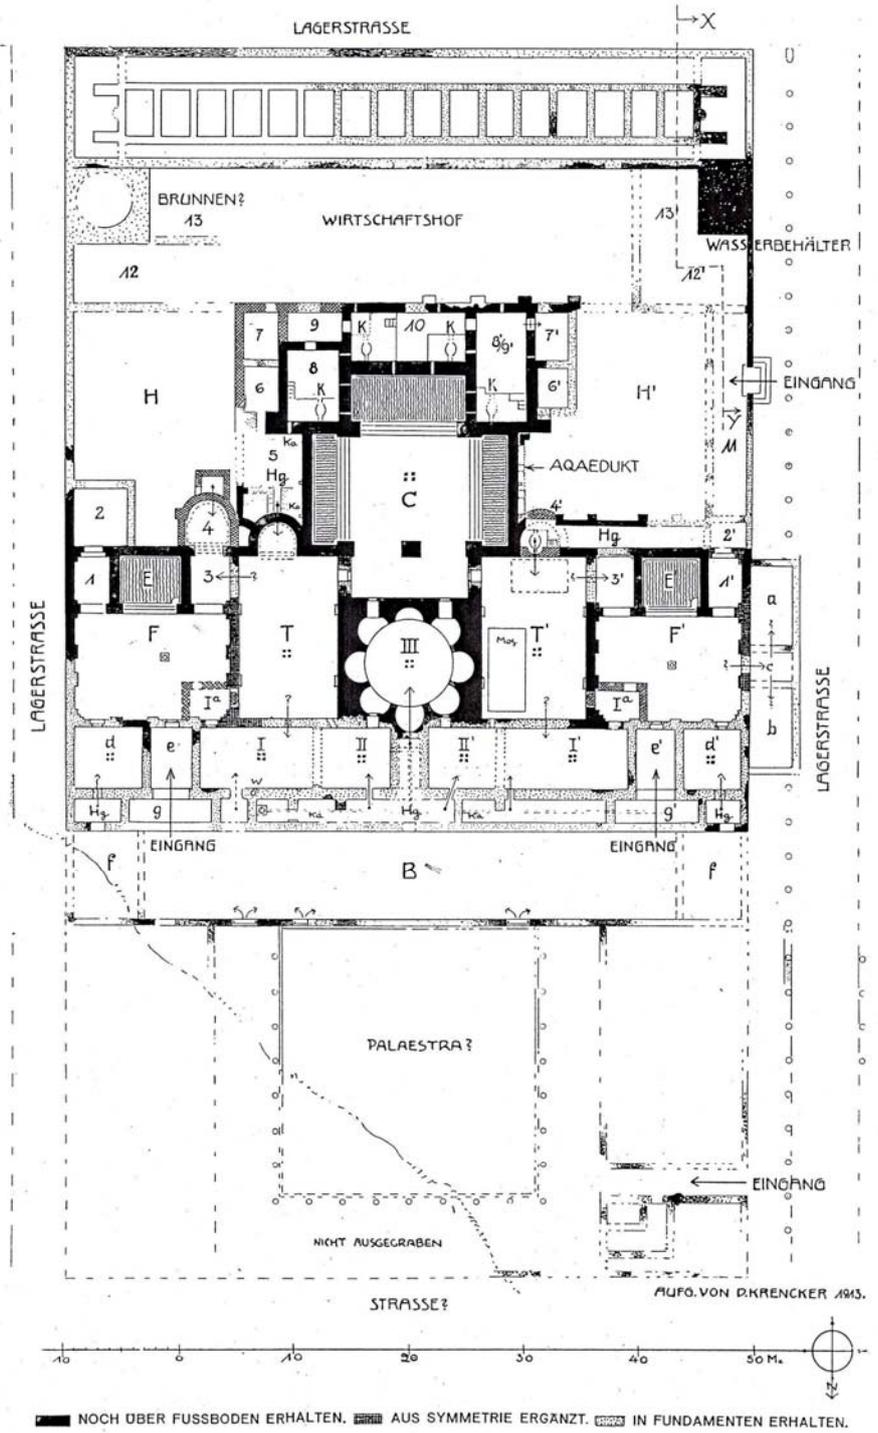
, Plan des thermes du camp. (Krencker, 1913)
